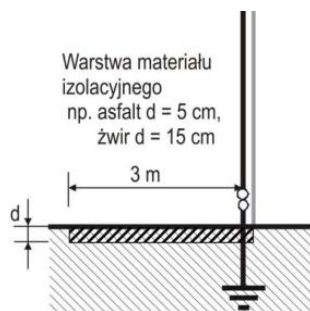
Sposób sterowania potencjałem na powierzchni gruntu celem zmniejszenia napięć dotykowych i krokowych.
